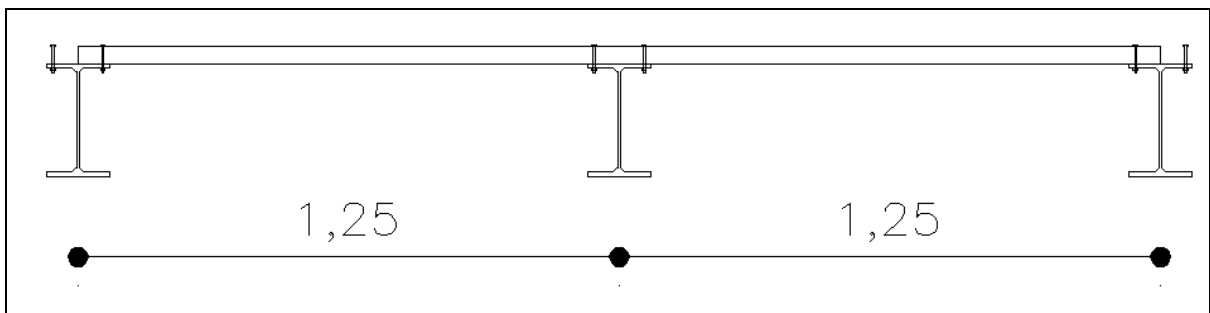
Ligação do painel Wall Wood na estrutura metálica
